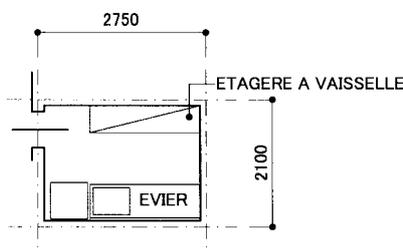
Plan planimétrique du local d'approvisionnement en eau chaude
